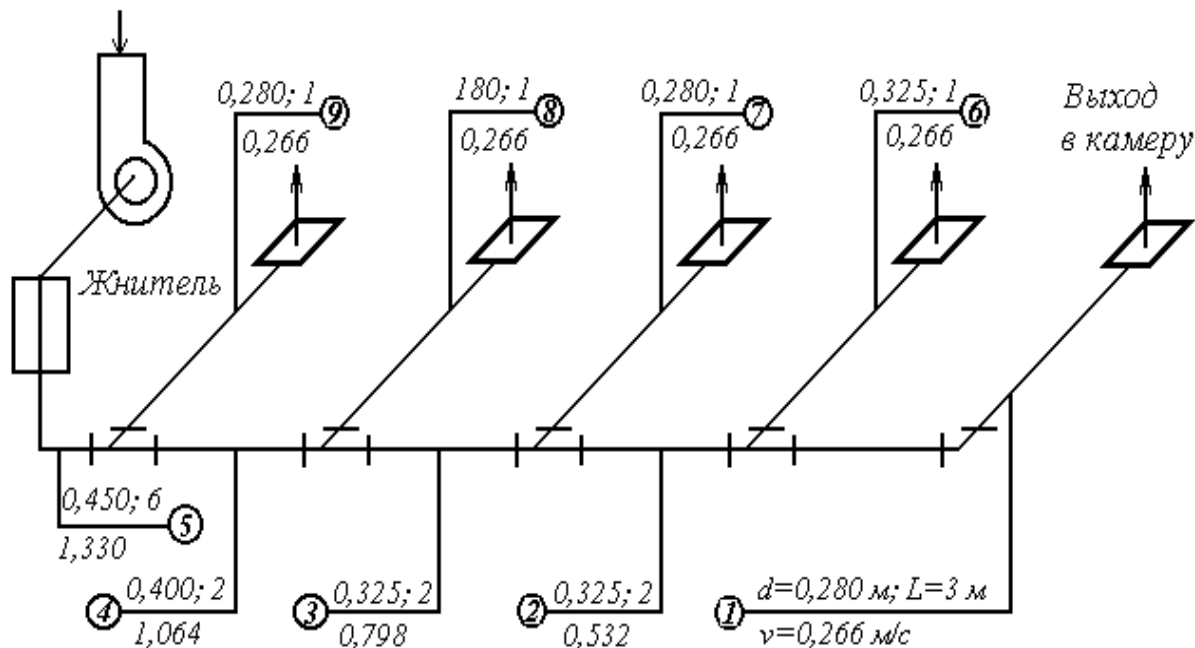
Расчетная схема общеобменной вентиляции
